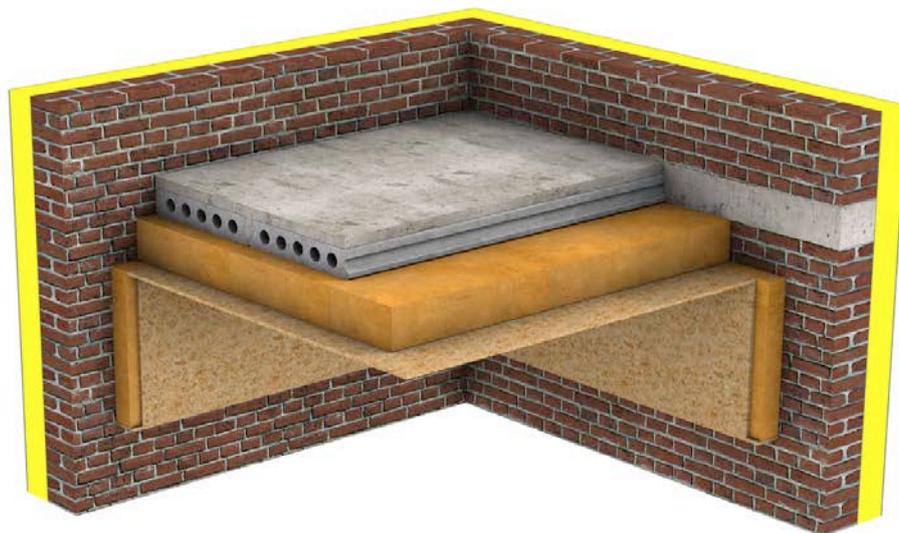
Isolation de la face inférieure d'un plancher en béton à l'aide d'un isolant rigide (vue 3D).
